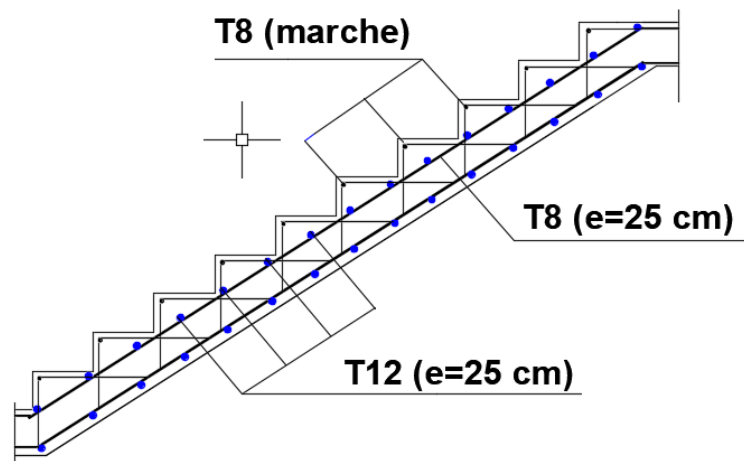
Schéma de ferrailage de l'escalier consol (volée 2).
